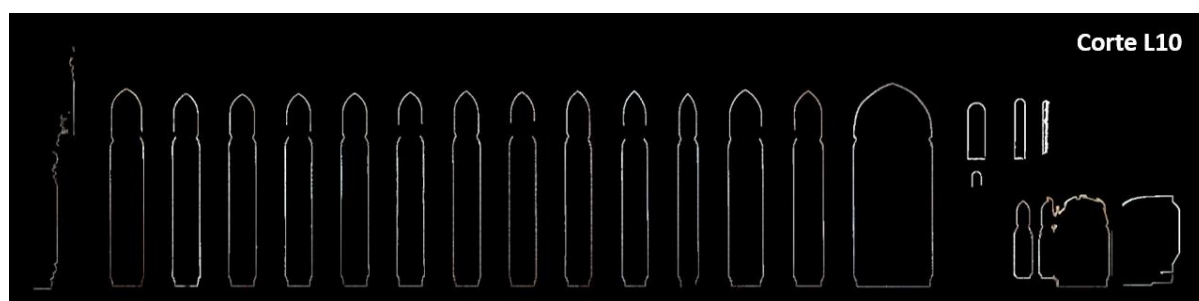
Corte longitudinal que intersecta o centro dos pilares que separam as Naves Norte e Central da Igreja (L10) do Mosteiro de Alcobaça.
